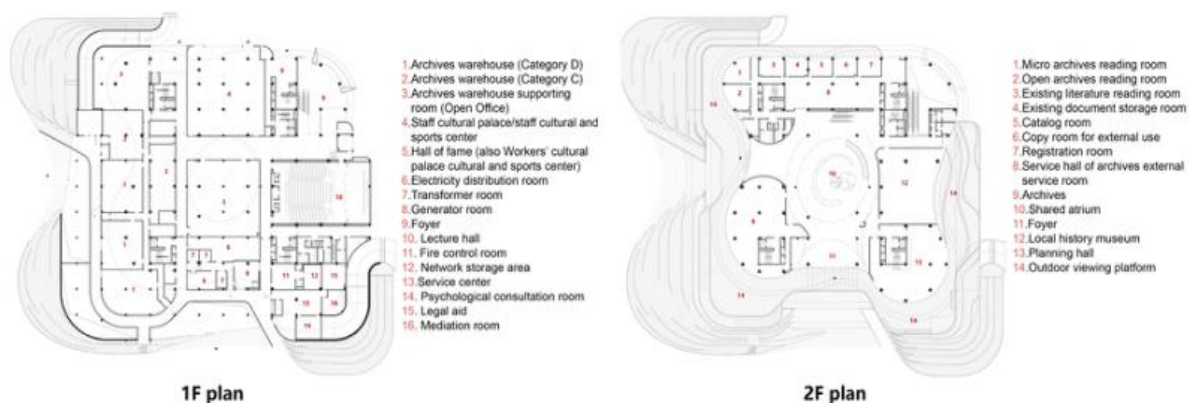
План першого поверху; Рис. 2.5. план другого поверху; [24].
